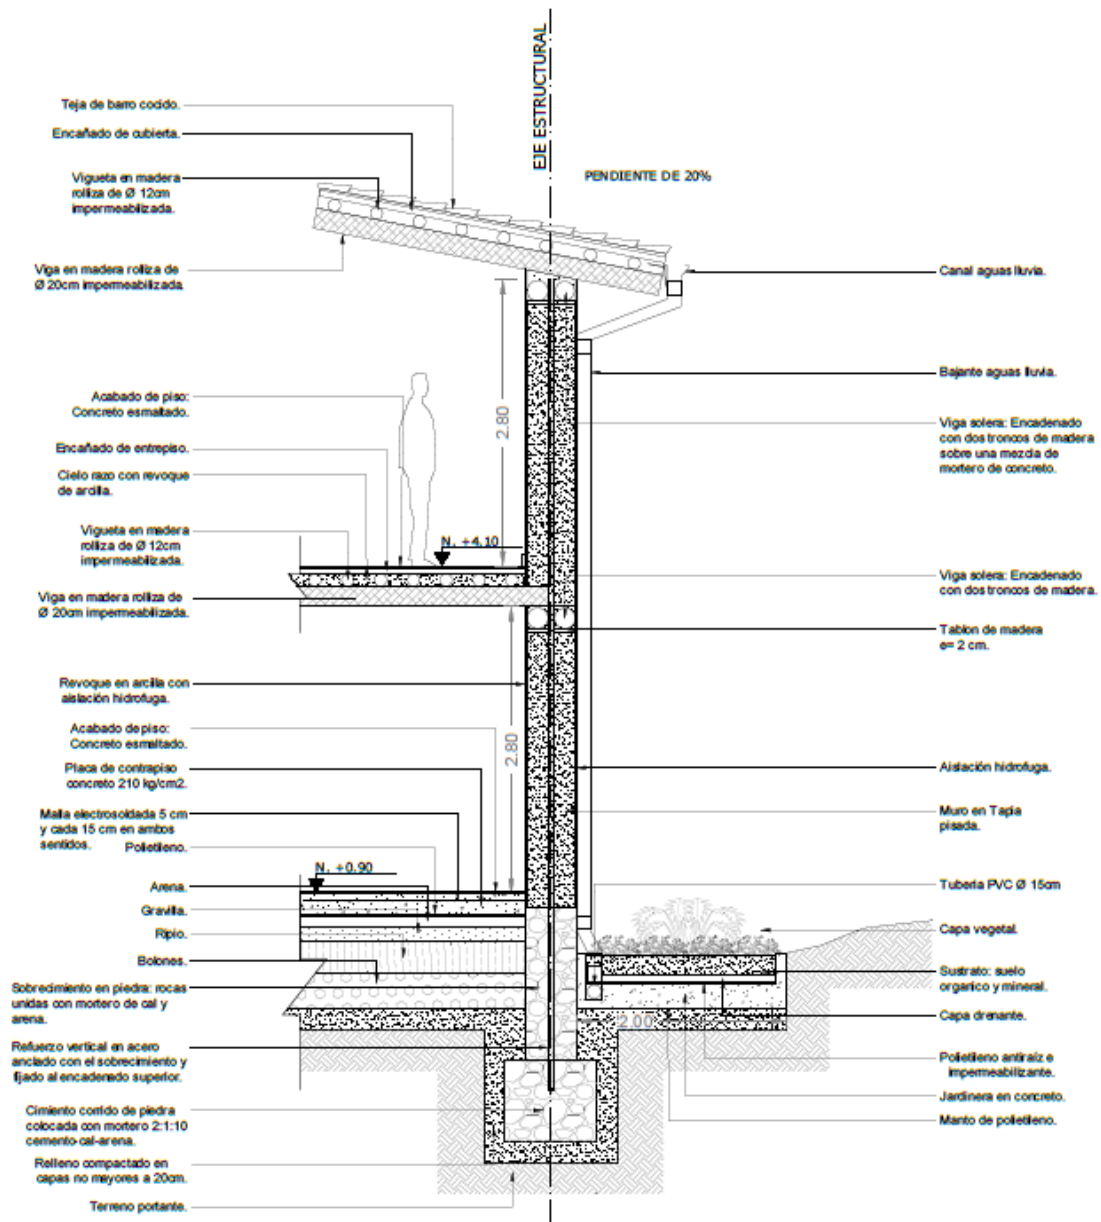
Corte fachada, muro en adobe reforzado. Fuente: planos de detalles de autoría propia según proyecto arquitectónico.
